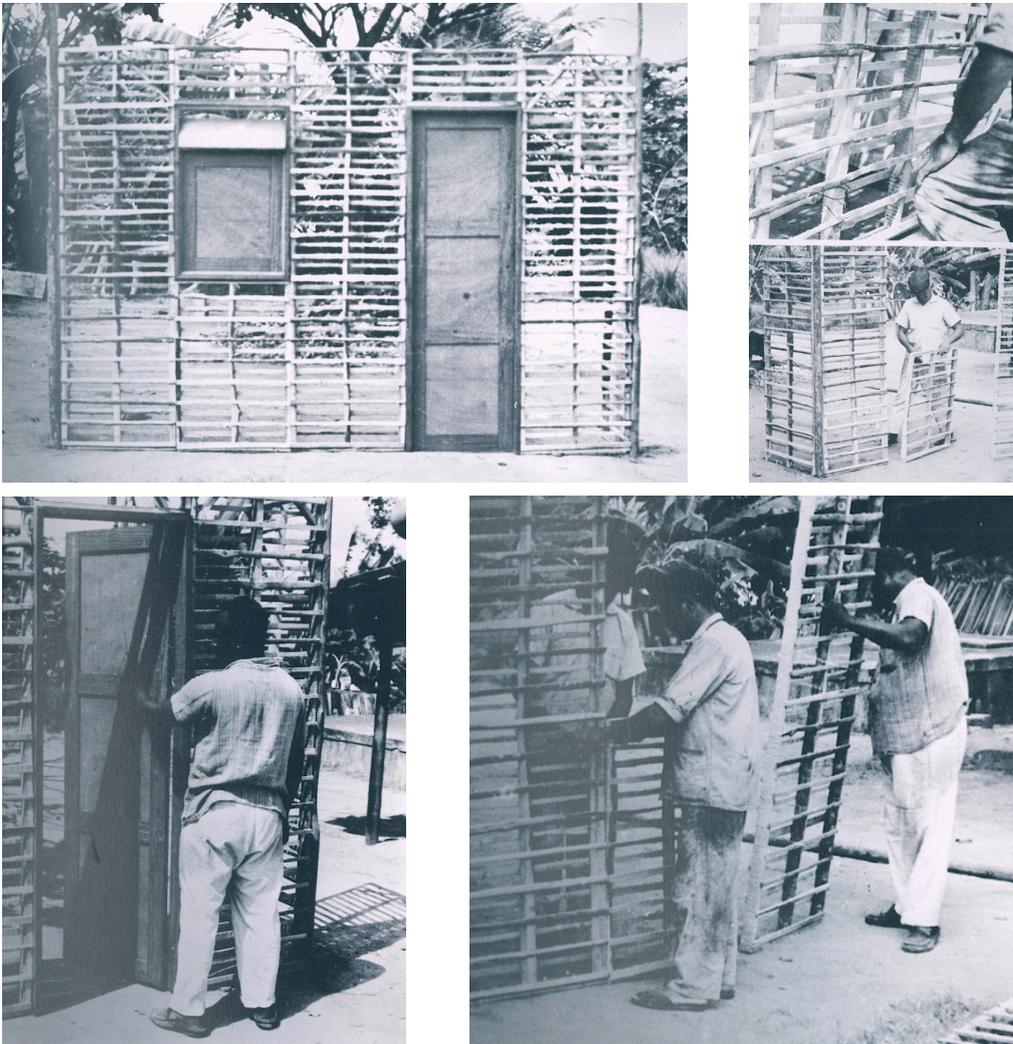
Fotos montaje paneles. Fuente: Archivo Acácio Gil Borsoi.
